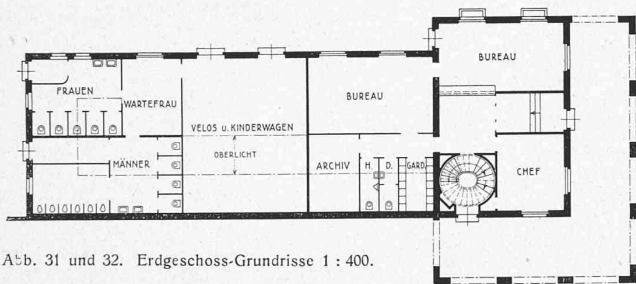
und 32. Erdgeschoss-Grundrisse 1 : 400.
